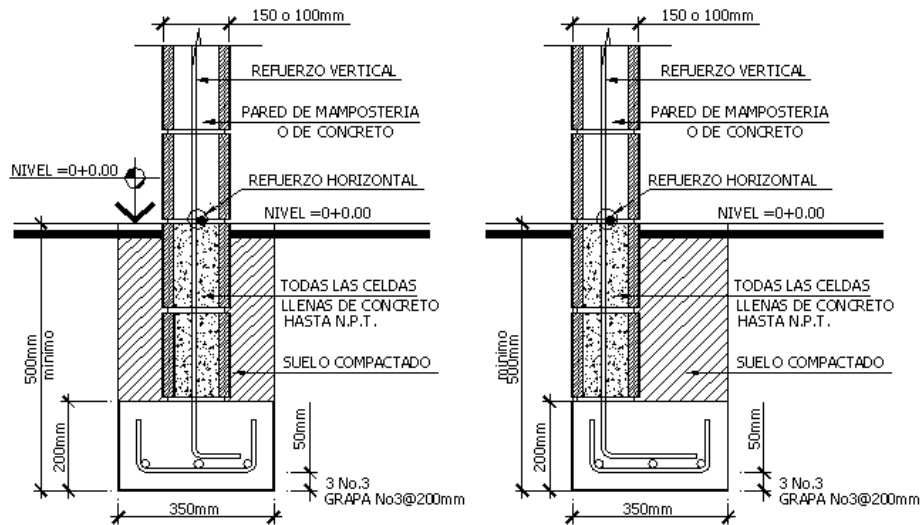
Soleras de fundación para viviendas de una planta. El gancho de la grapa de 90 grados puede ser sustituido por gancho de 180 grados
